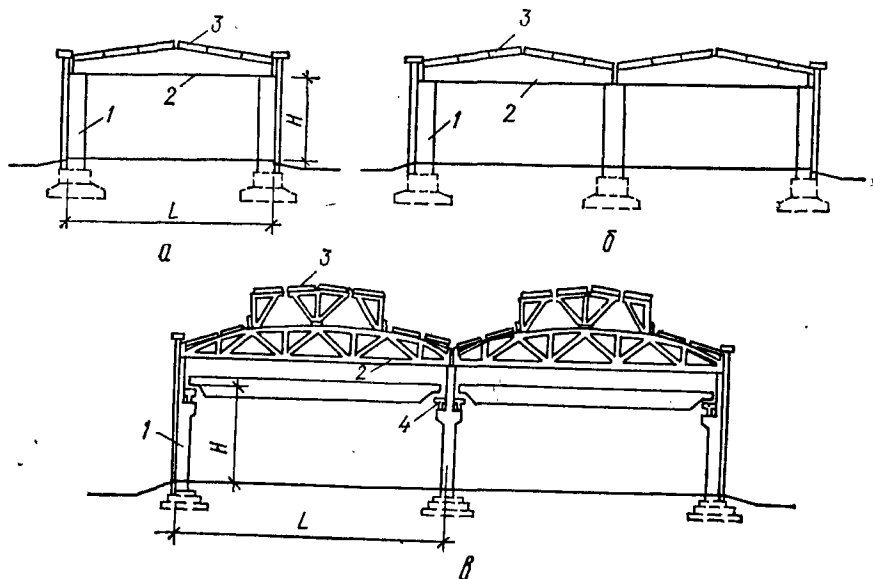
Схемы поперечных рам каркасов одноэтажных зданий с типовыми железобетонными конструкциями:
